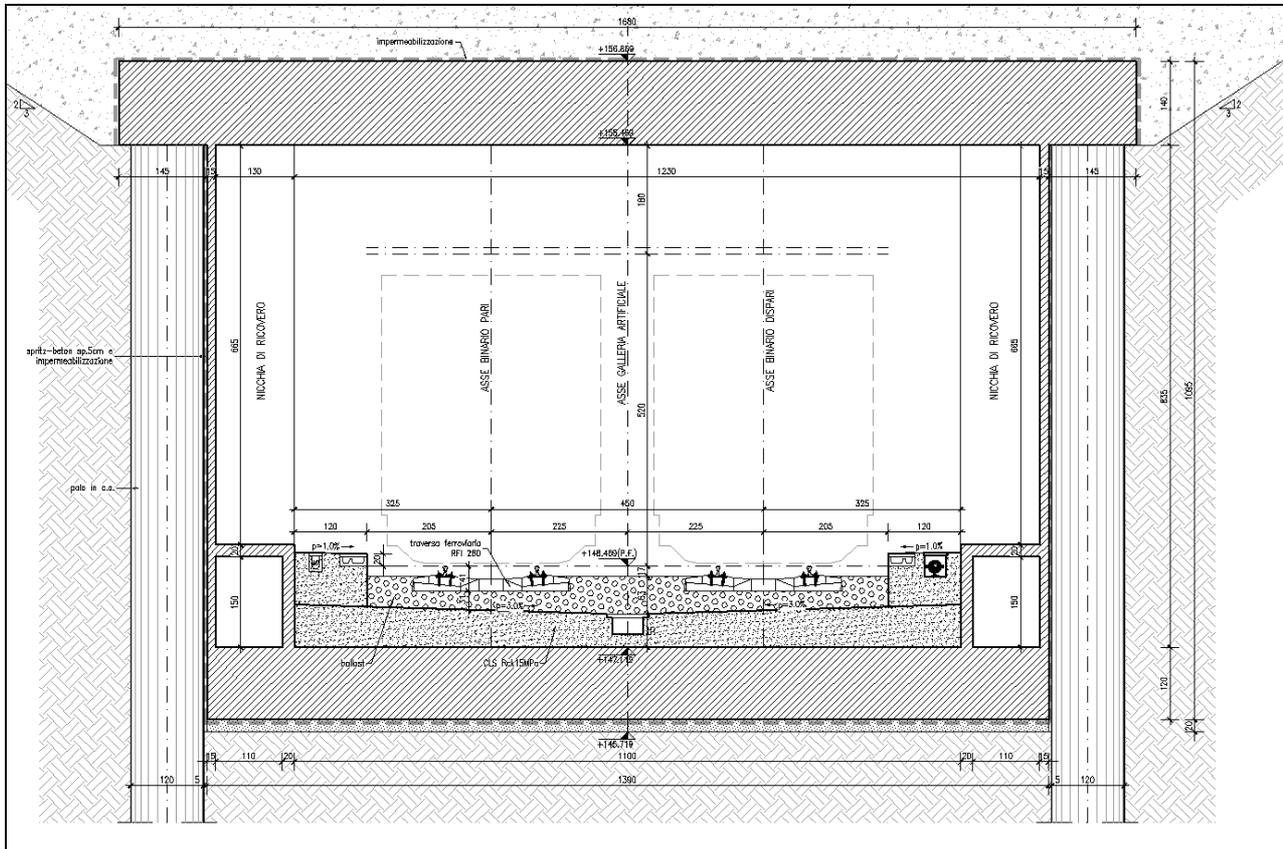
Sottopasso ferroviario. Sezione trasversale sezione allargata
